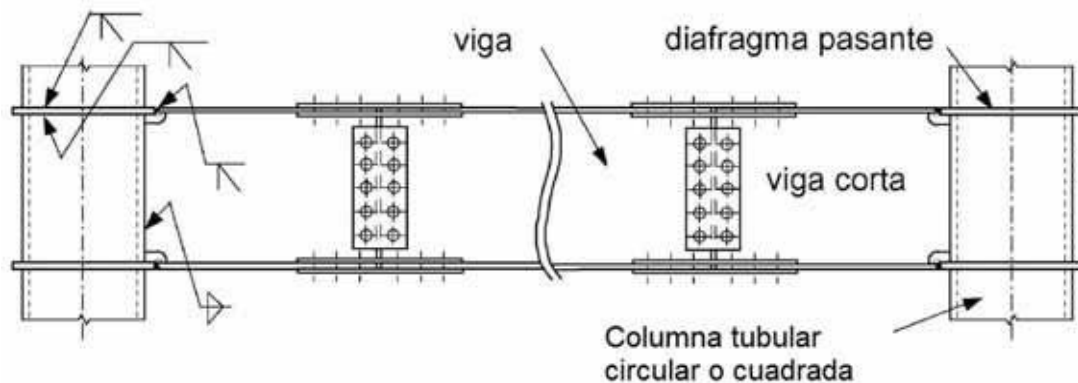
Conexión viga-columna con diafragmas pasantes de típica utilización en Japón
